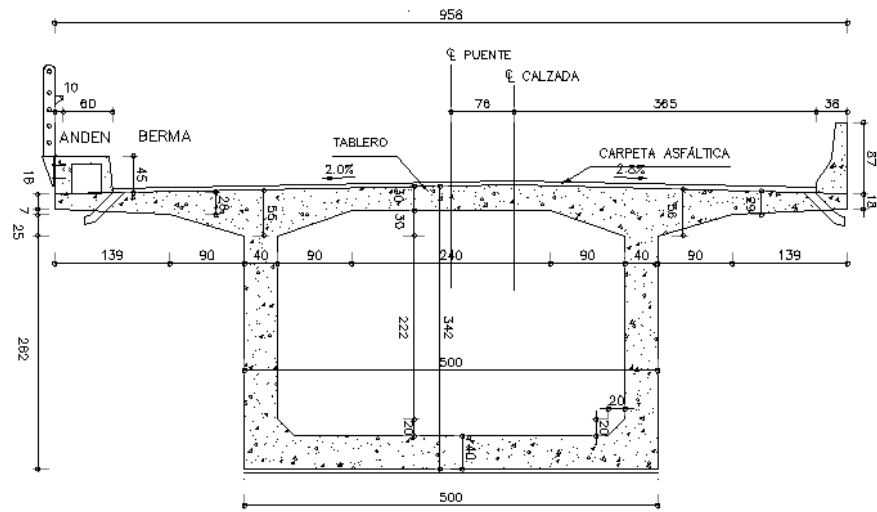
Sección transversal sobre pila - Puente Bermúdez
